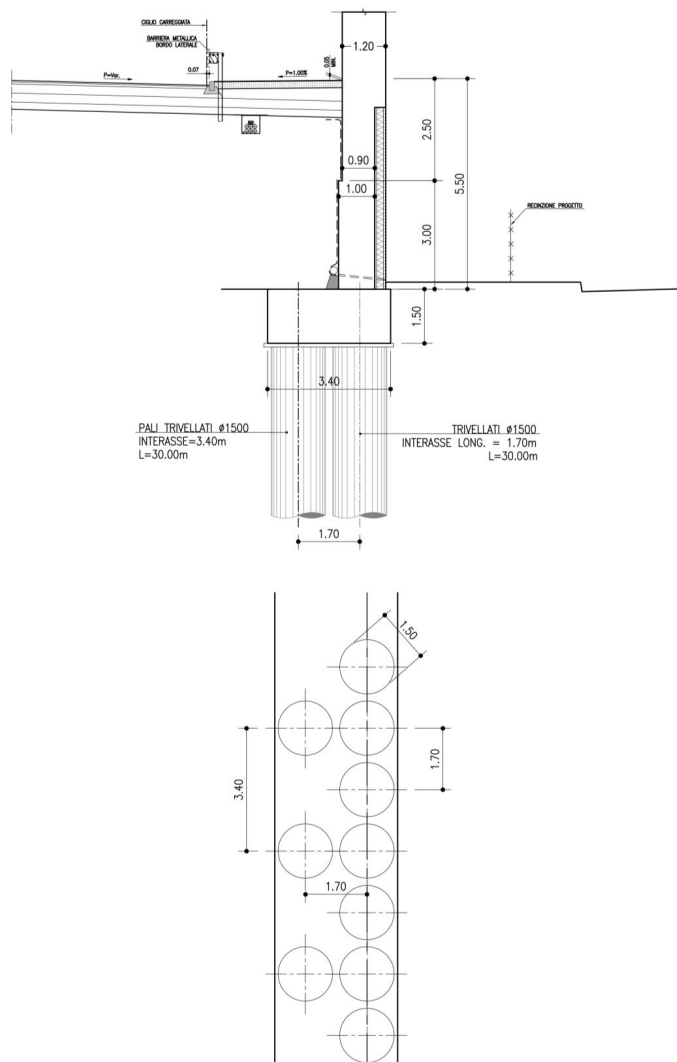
Fondazioni sezione tipologica piastra c.a.
